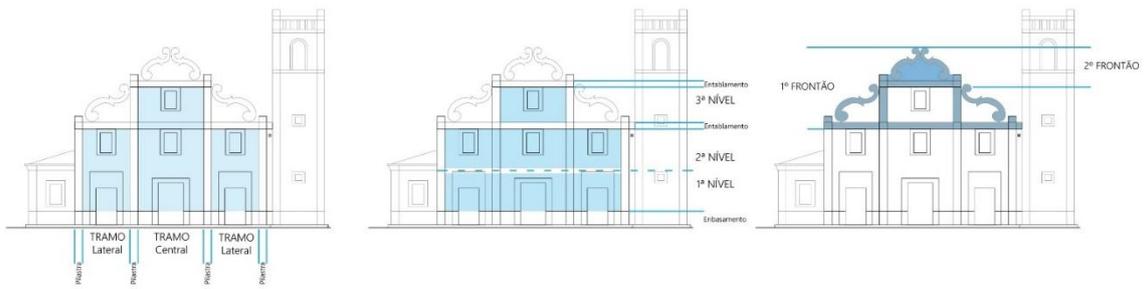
Sistematização tipo da composição da fachada; Elaborado por Vieira.
